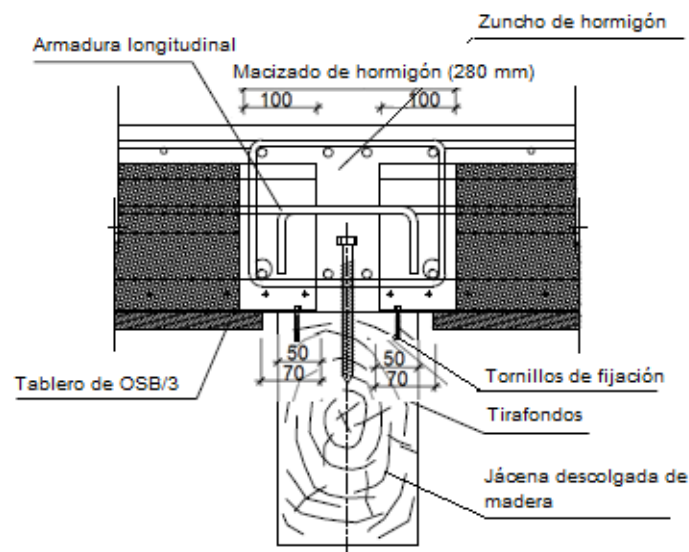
Apoyo frontal de forjado con el sistema SES™ sobre jácena descolgada de madera.
